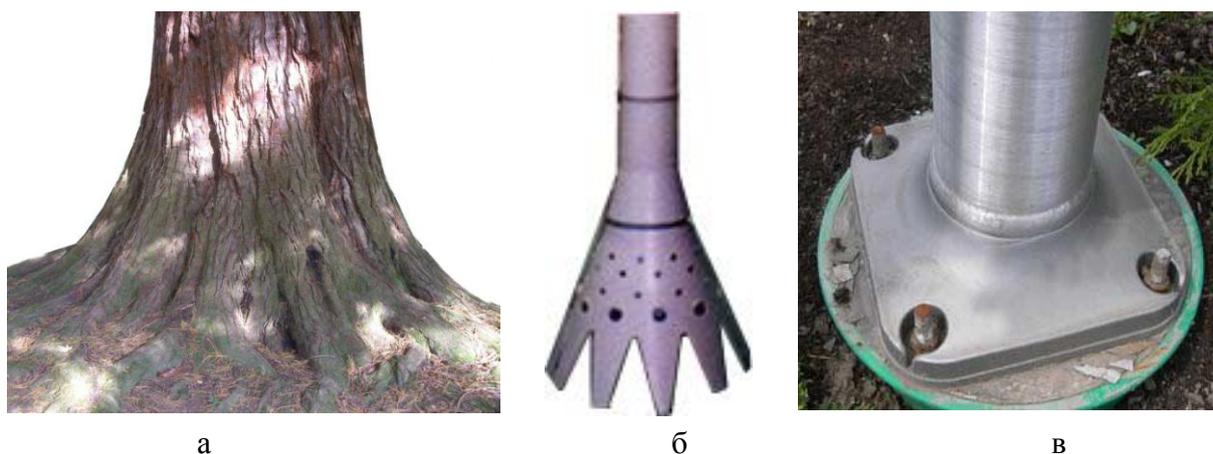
7. Нижняя часть: а – ствола лиственницы, б – Останкинской телебашни, в – сварной конструкции
